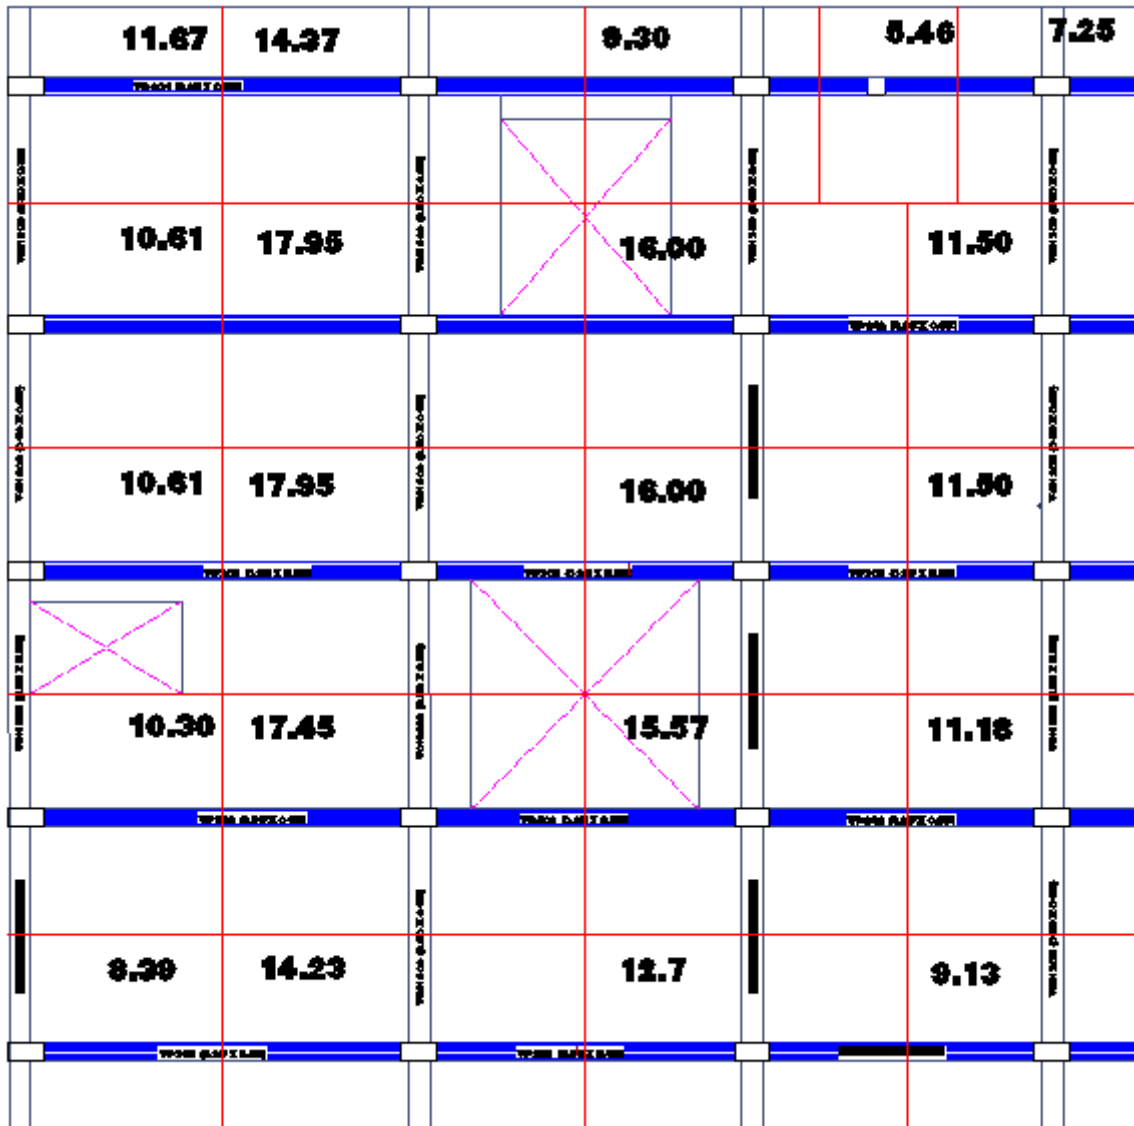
Ubicación en planta y área de tributaria de Columnas – 2 al 5 Piso.
